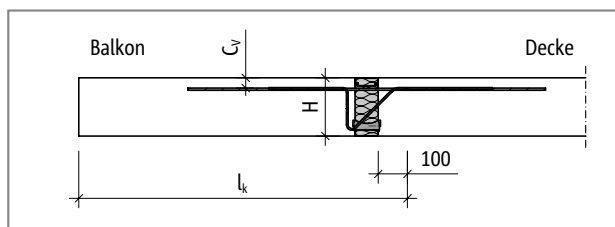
Schöck Isokorb® Typ K: Statisches System
